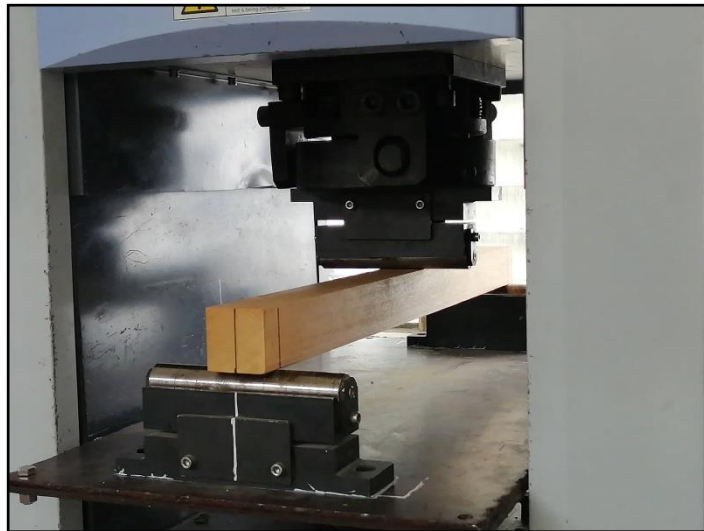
Probeta al inicio del ensayo mecánico de flexión
